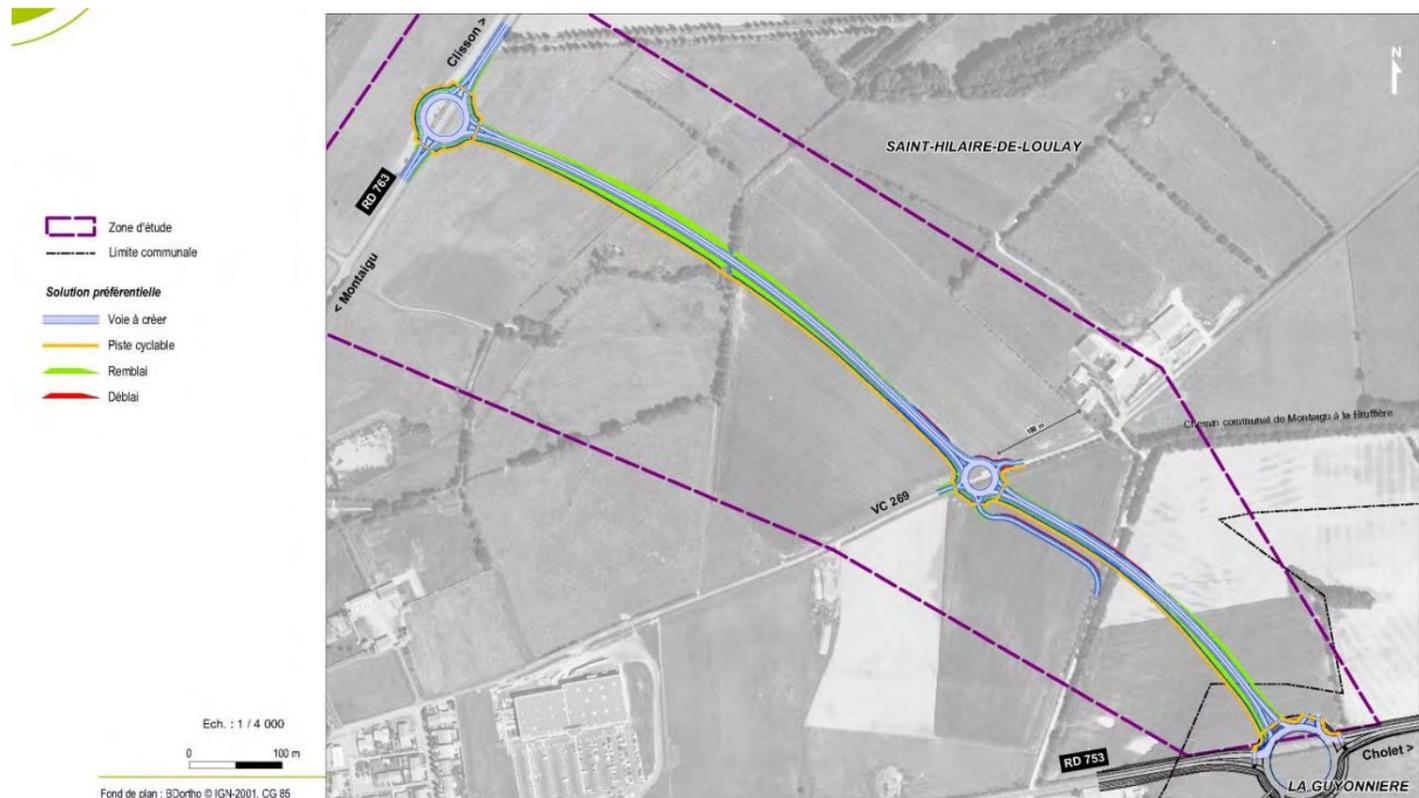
Plan de prolongement du contournement, barreau RD753/RD763
